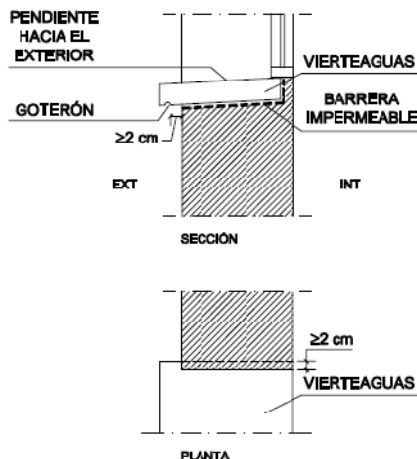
Detalle encuentro carpintería y cerramiento, sección vertical.
